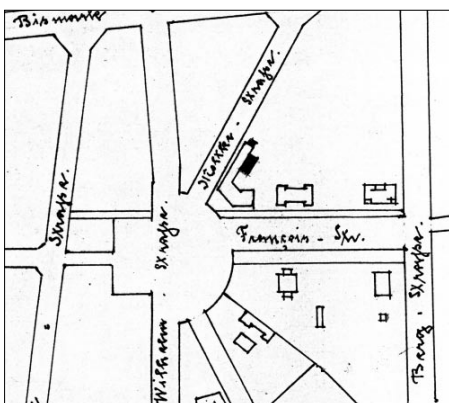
Lageplan der Landesvermessung (NNA, Kartensammlung Nr. 4984)
